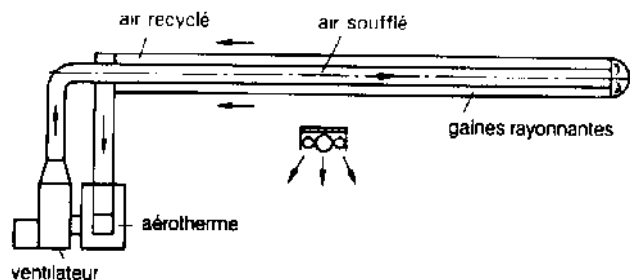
Principe d'un chauffage par rayonnement à air surchauffée.
